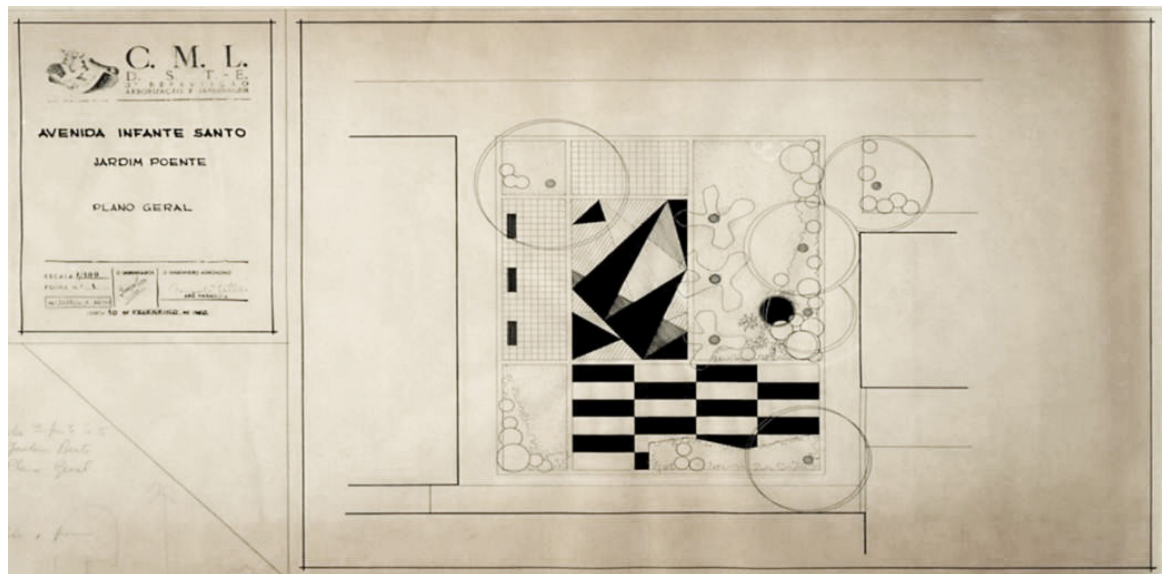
Avenida Infante Santo. Jardim poente. Plano Geral. Ribeiro Telles, 1960.
